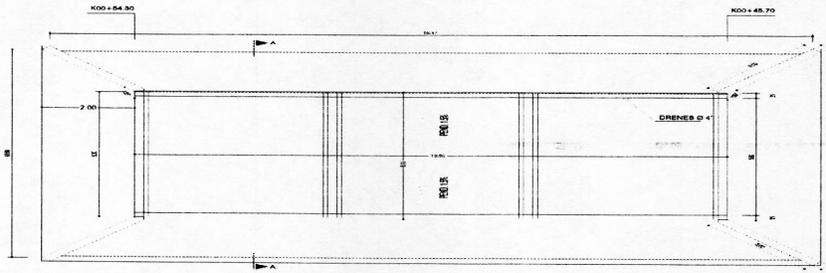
Vista en planta del box culvert de 12,00 x 3,00 mt
